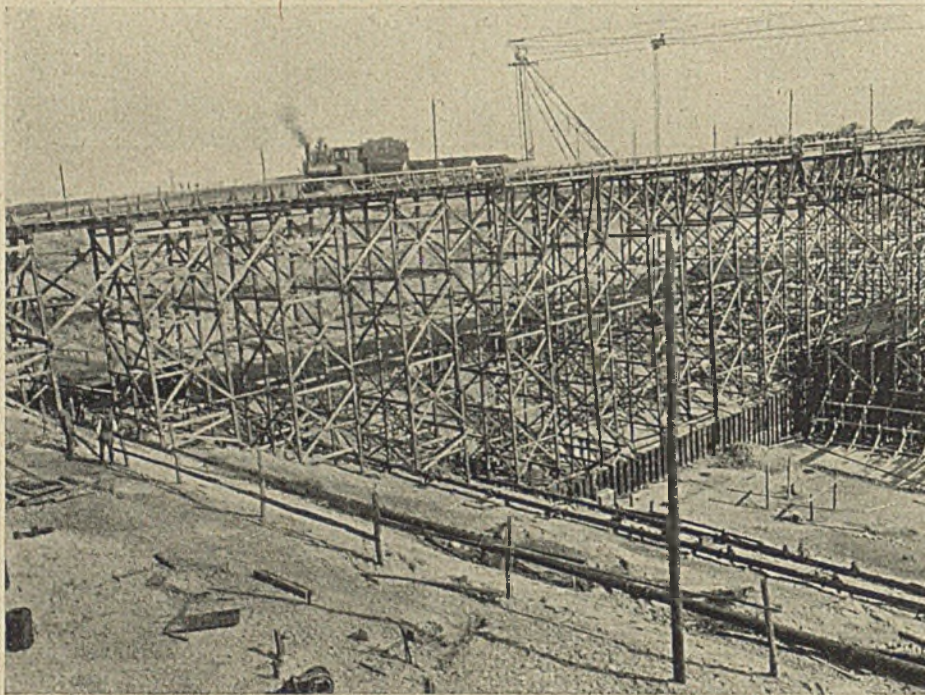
Betonzug auf dem 25 m hohen Gerüst der Schleusenbaustelle.
